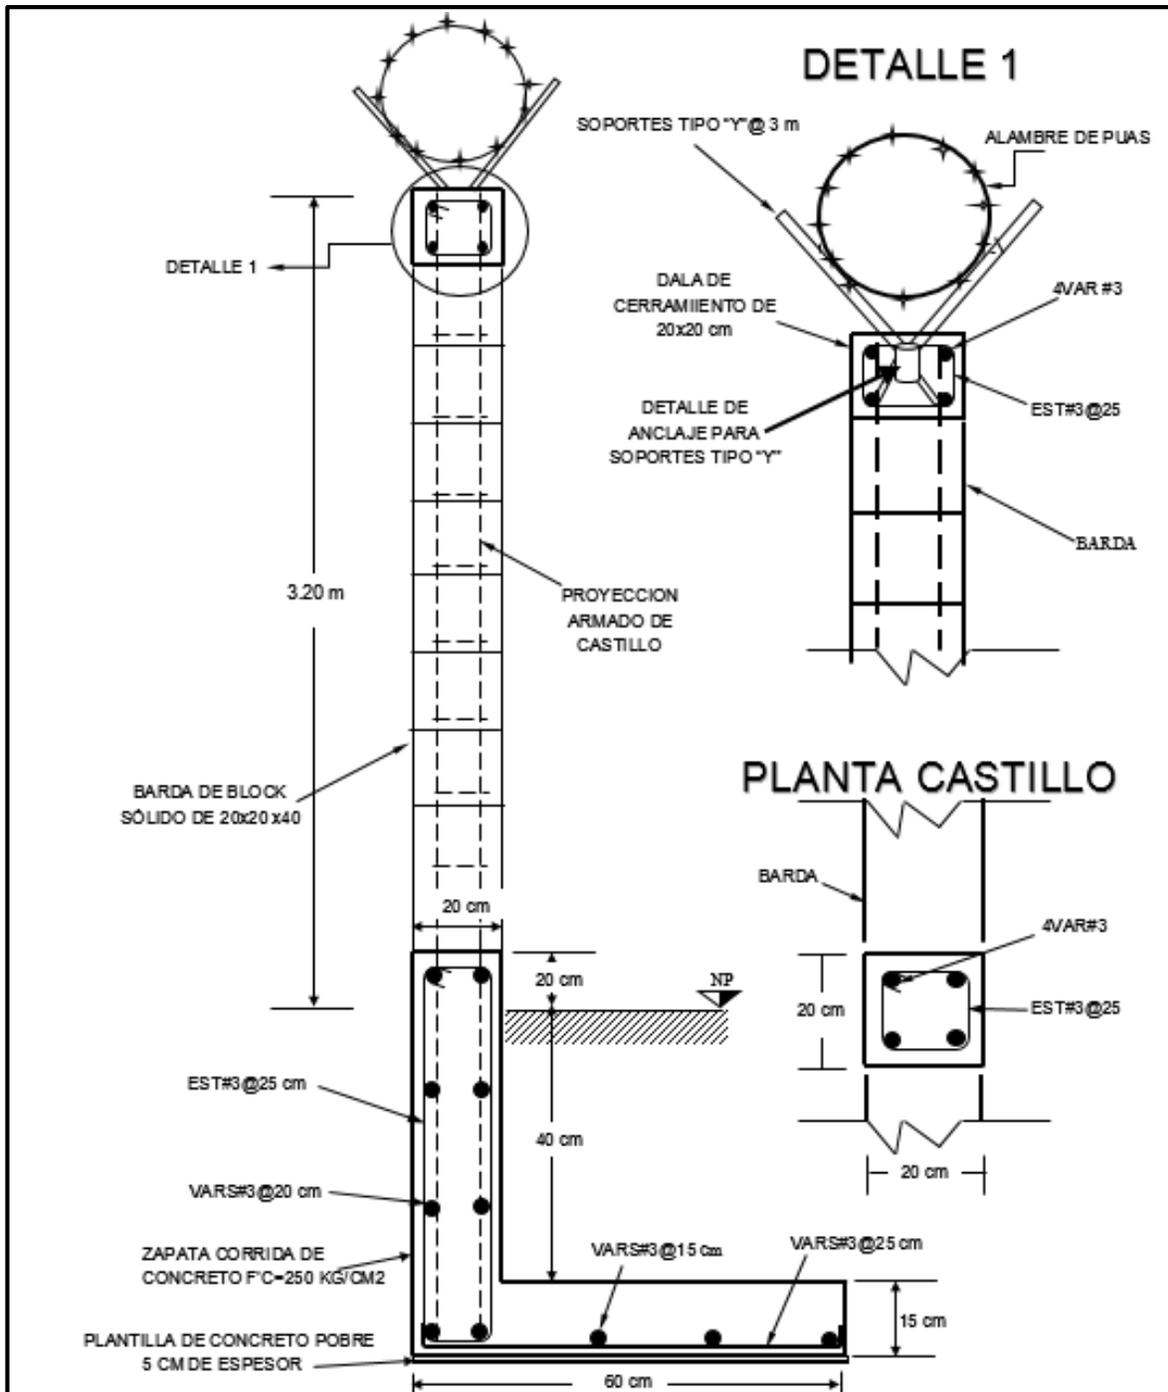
Disposición y armado de zapata corrida, dala de cerramiento y castillos
